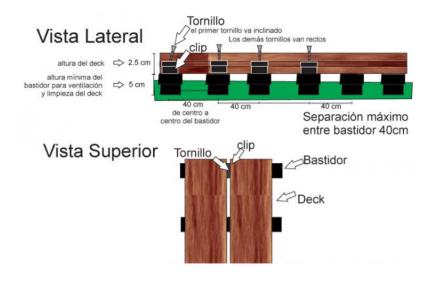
Detalle de deck de madera sobre un contrapiso de hormigón
